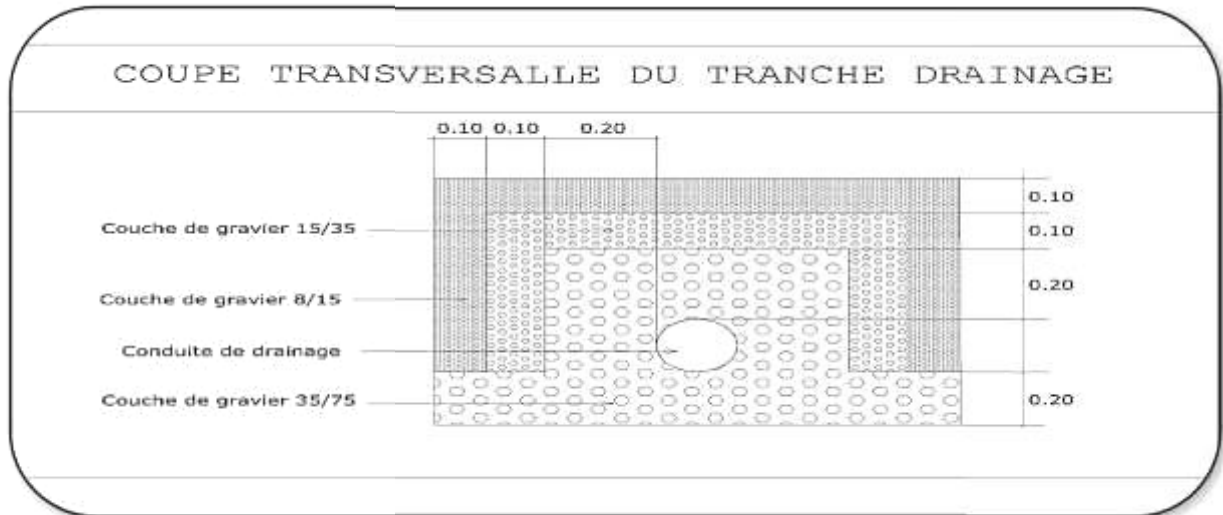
Coupe transversale du tranche de drainage horizontale. (ONA 2008)
